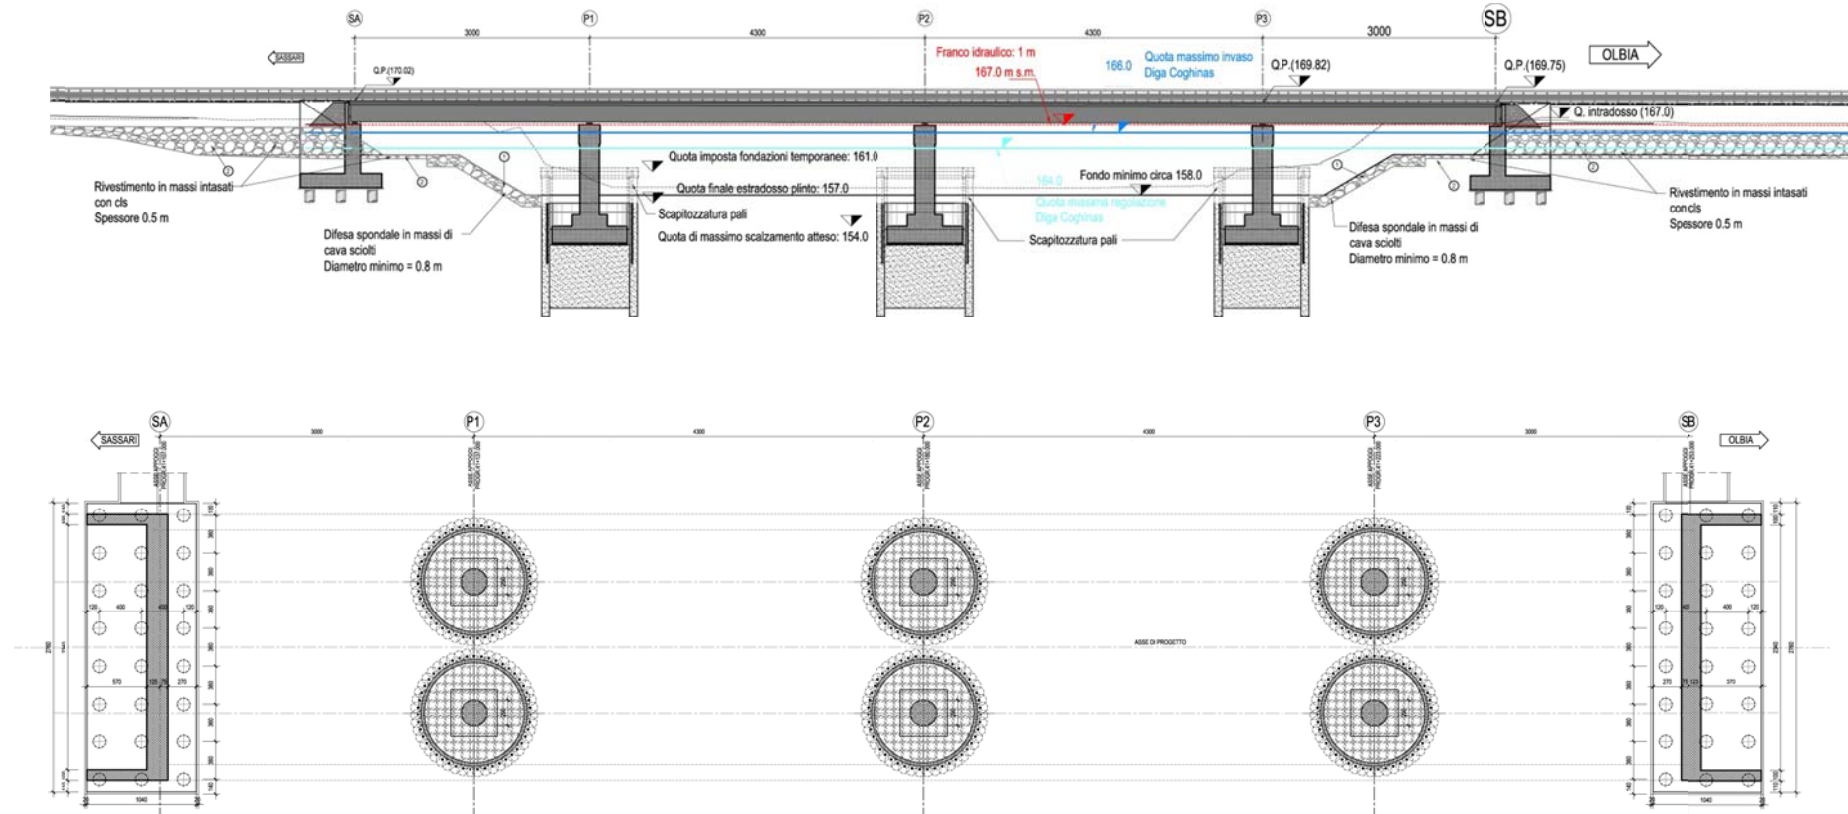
Sezione longitudinale e planimetria del ponte della SS597 in progetto
